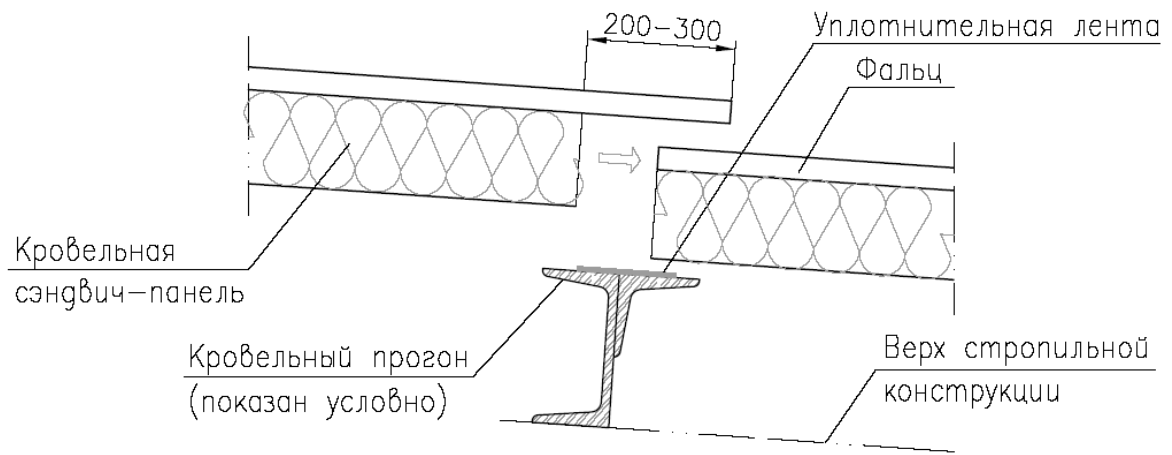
Нахлест кровельных панелей. Начало монтажа
